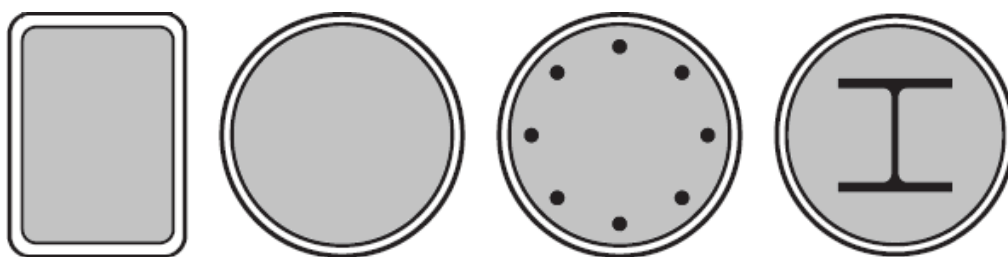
Pilares mistos preenchidos com concreto. Fonte: CEN (2004B).
